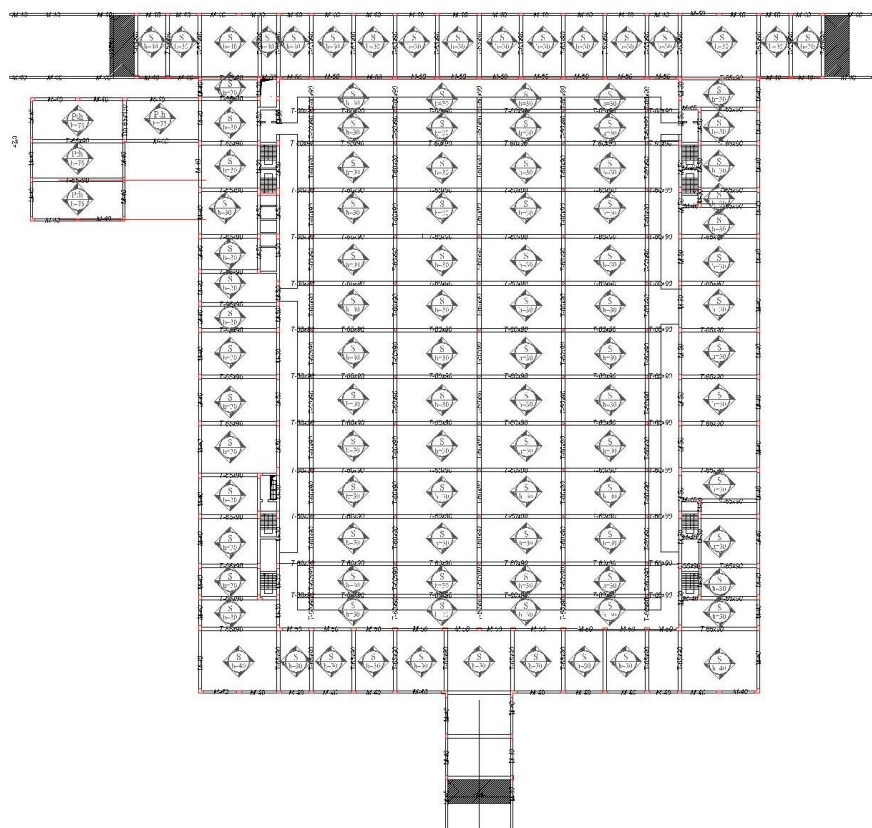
Plani i kolonave dhe strukturave ne kuoten -4.00 m
